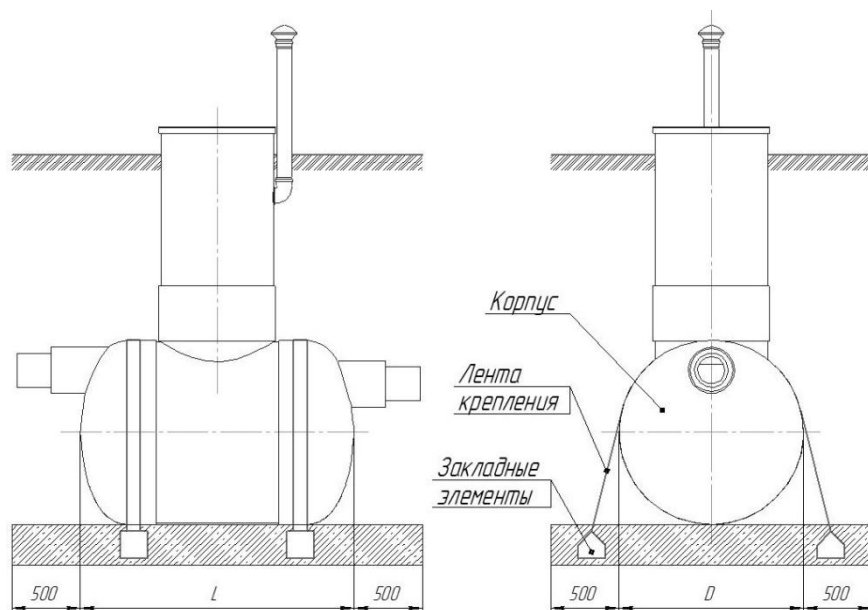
Пример монтажа оборудования на бетонное основание.
